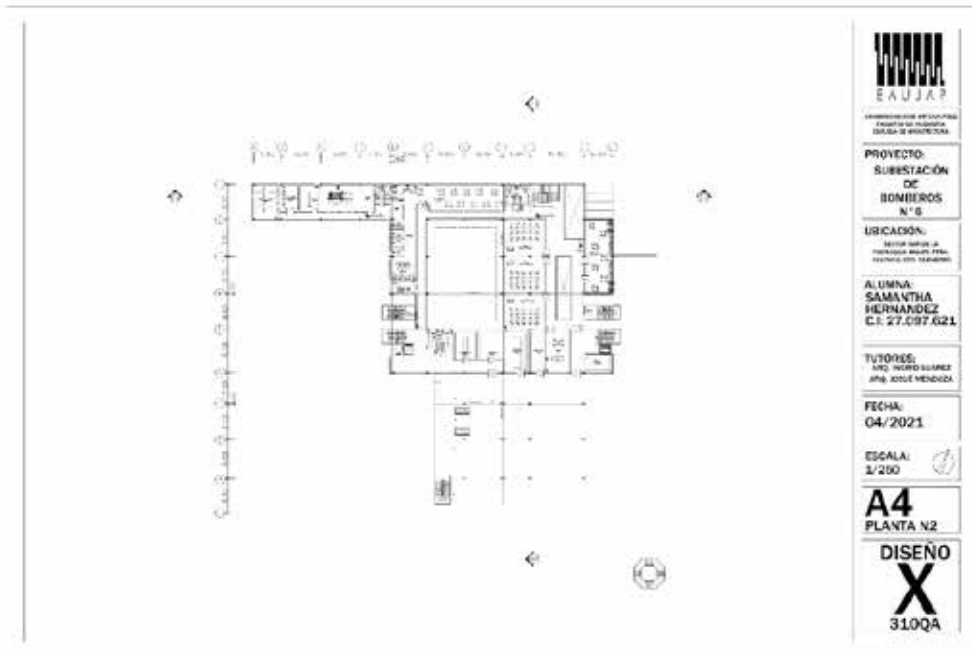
Planta Nivel 2 A4. Fuente: La Autora (2021)
